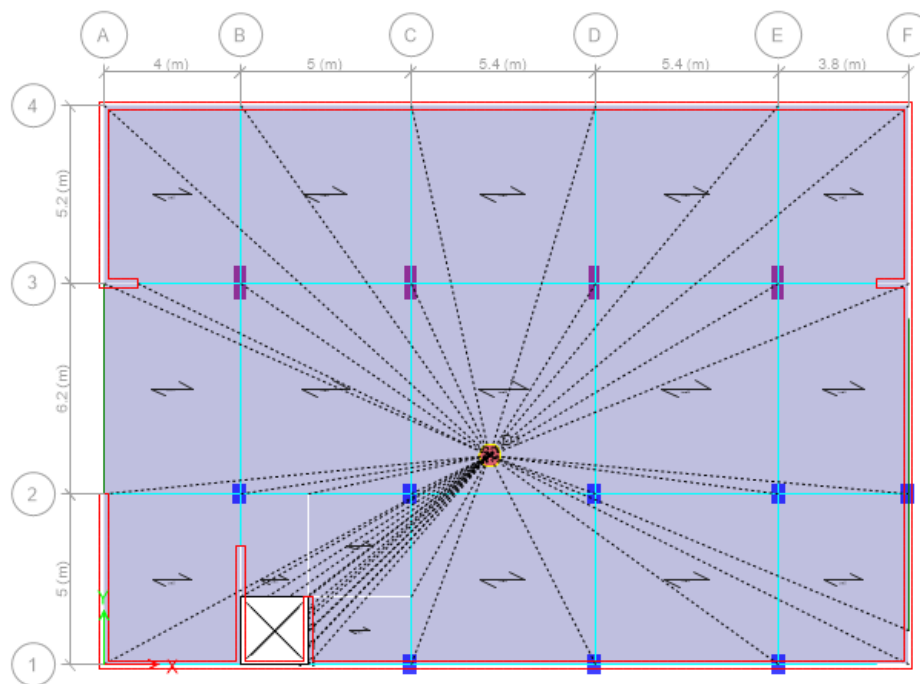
A: Vista en planta de la estructura analizada. Fuente: Elaboración propia.
